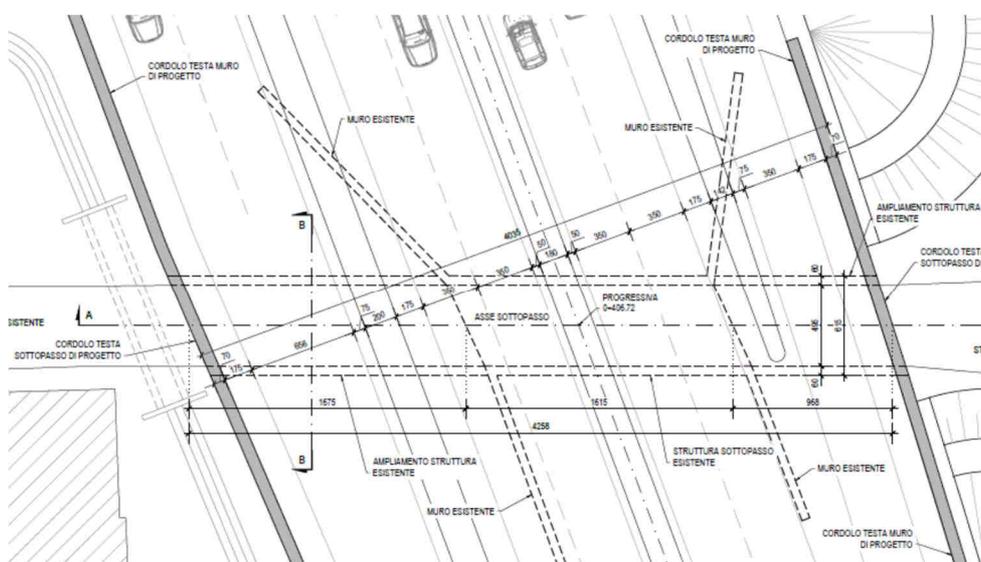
Planimetria – Sottovia svincolo SS.131dir
